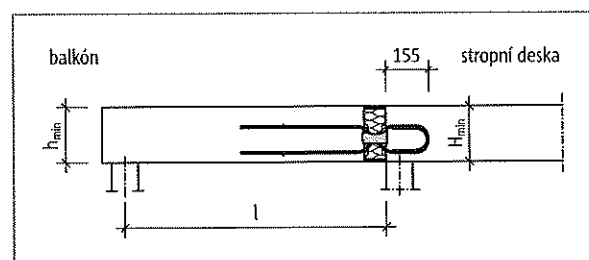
Schöck Isokorb® T typ QL-V4 až QL-V6: Statický systém
